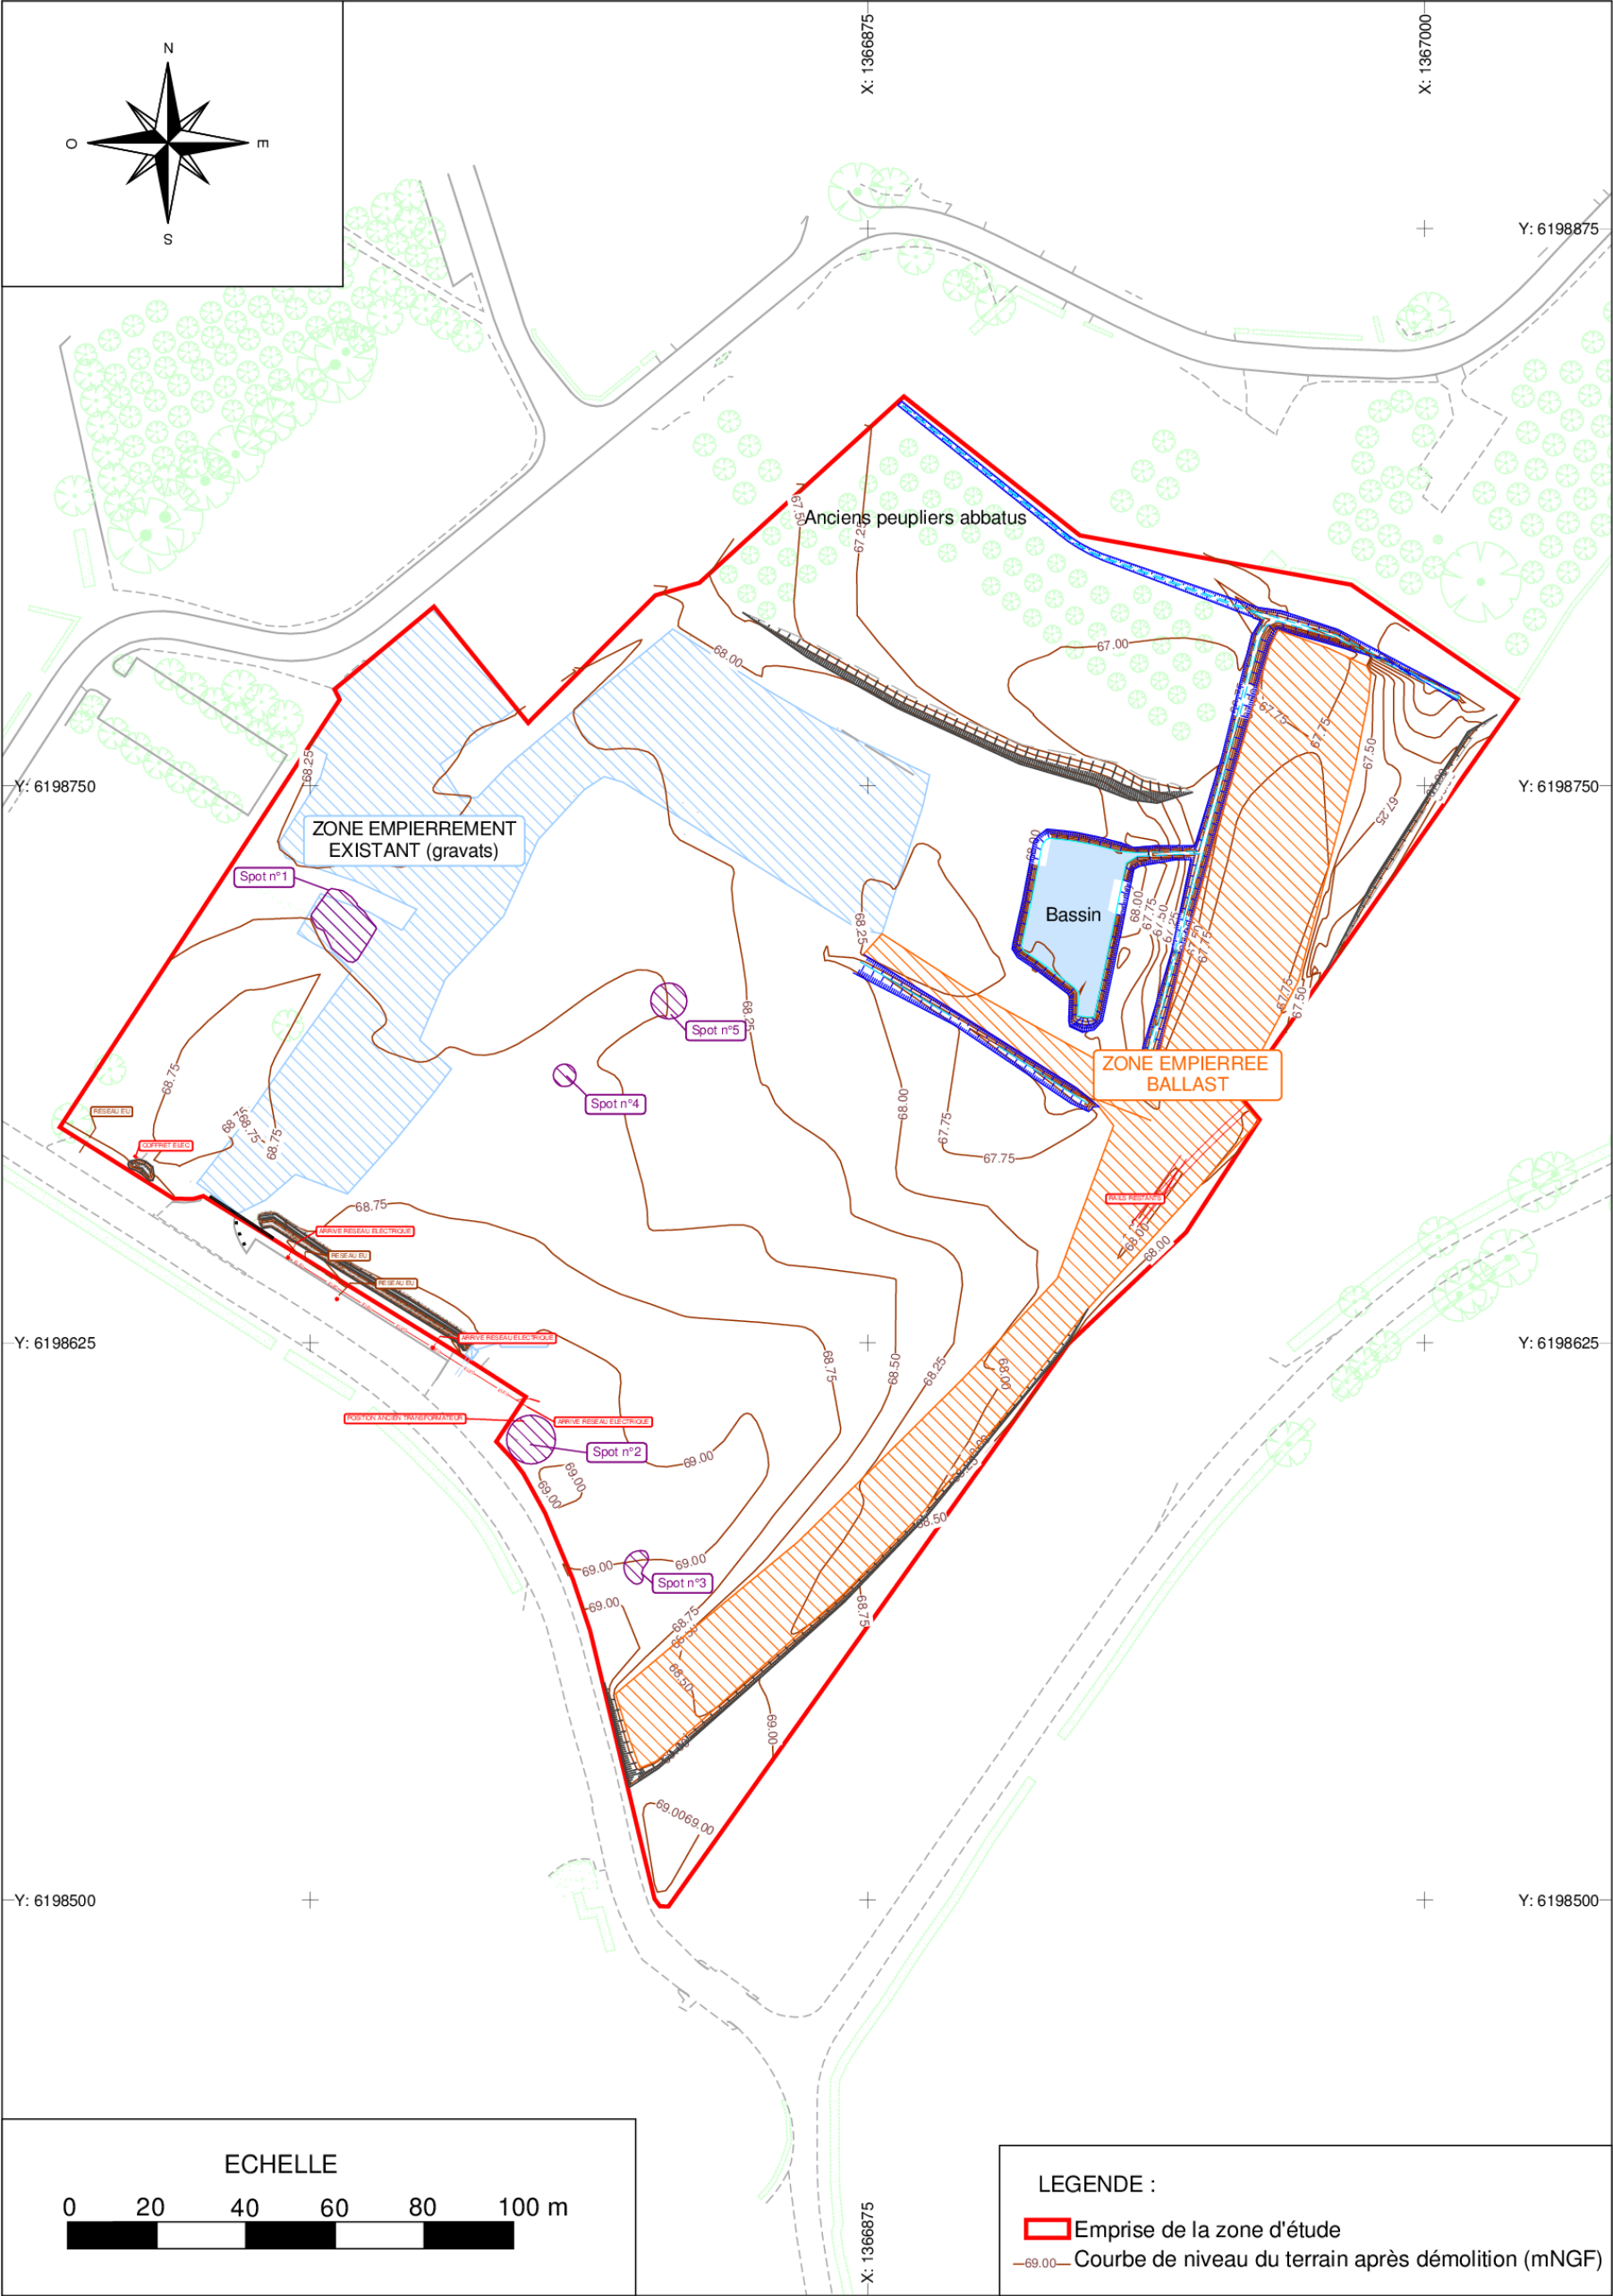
Description du site (fond de plan : plan de récolement ind. B – COLAS)
